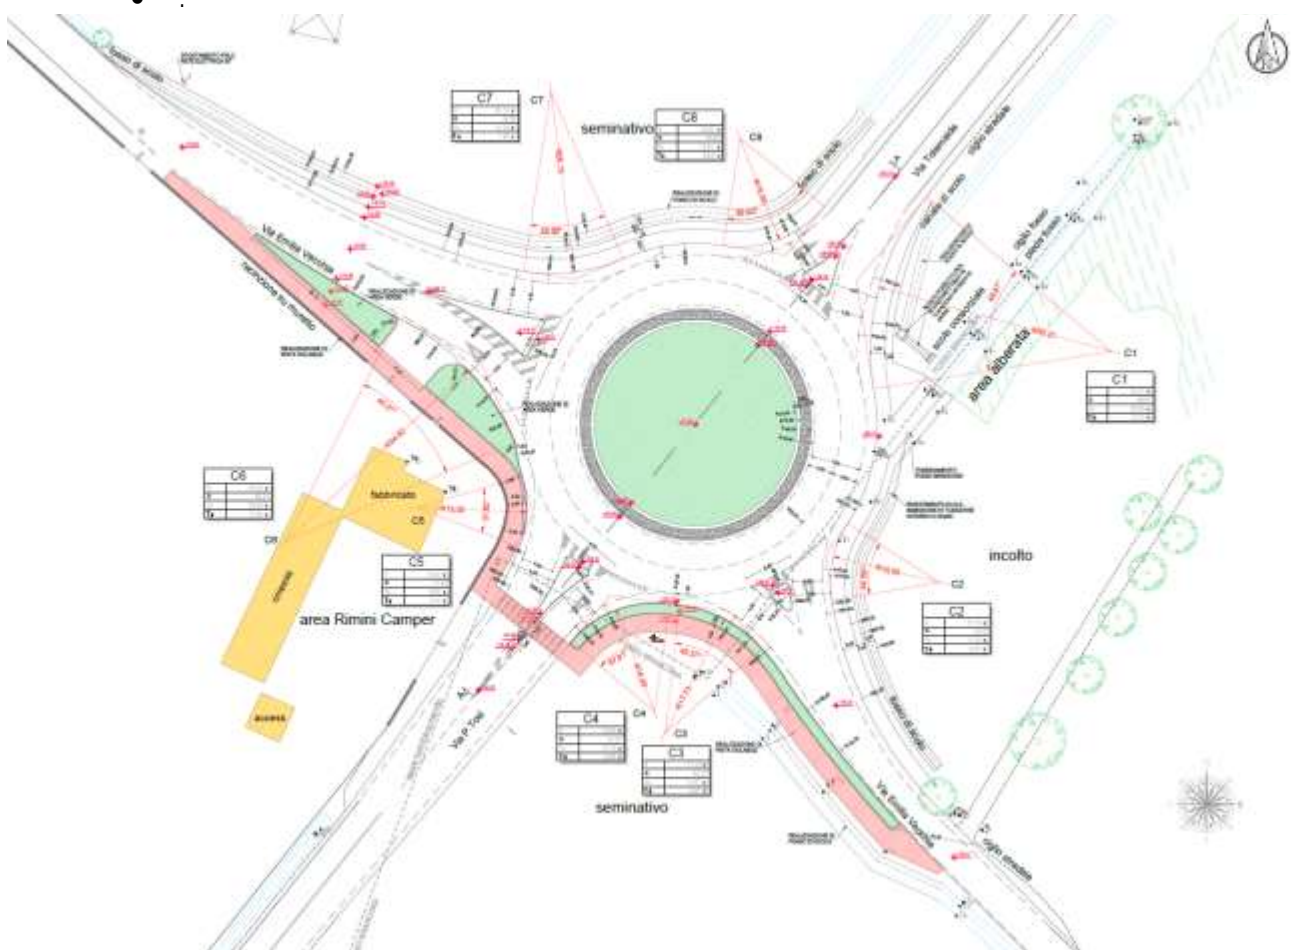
a – planimetria di progetto con traccia di sezione AA
